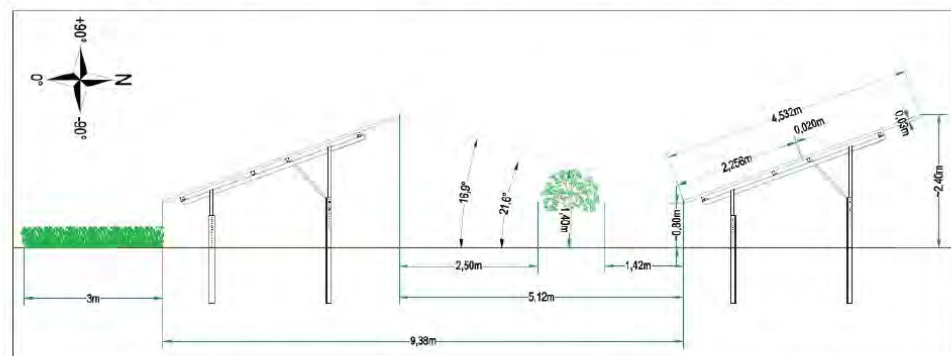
schéma de disposition des chênes truffiers par rapport aux panneaux solaires
